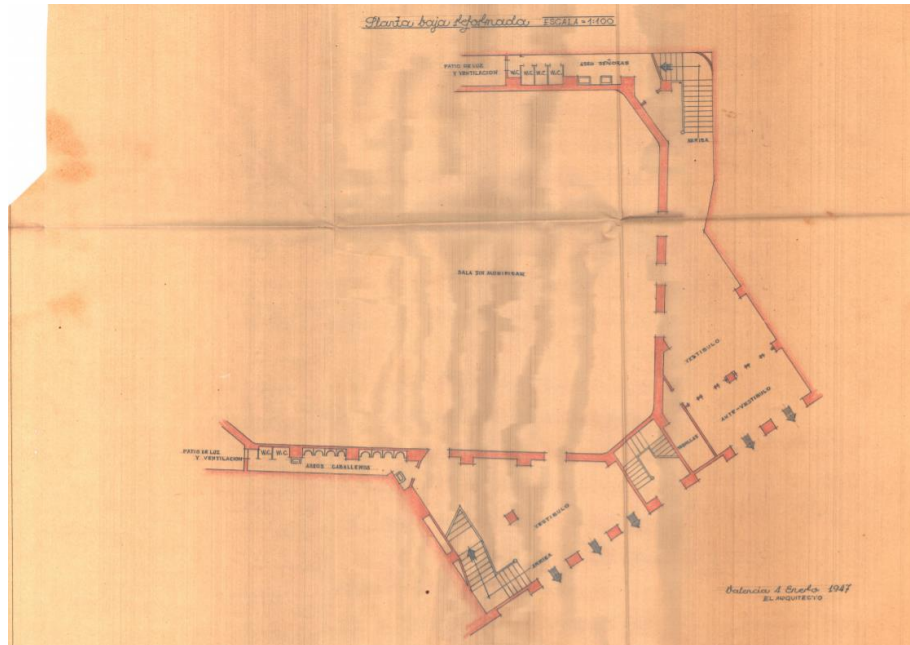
Plano planta baja de la actuación de Joaquín Rieta
